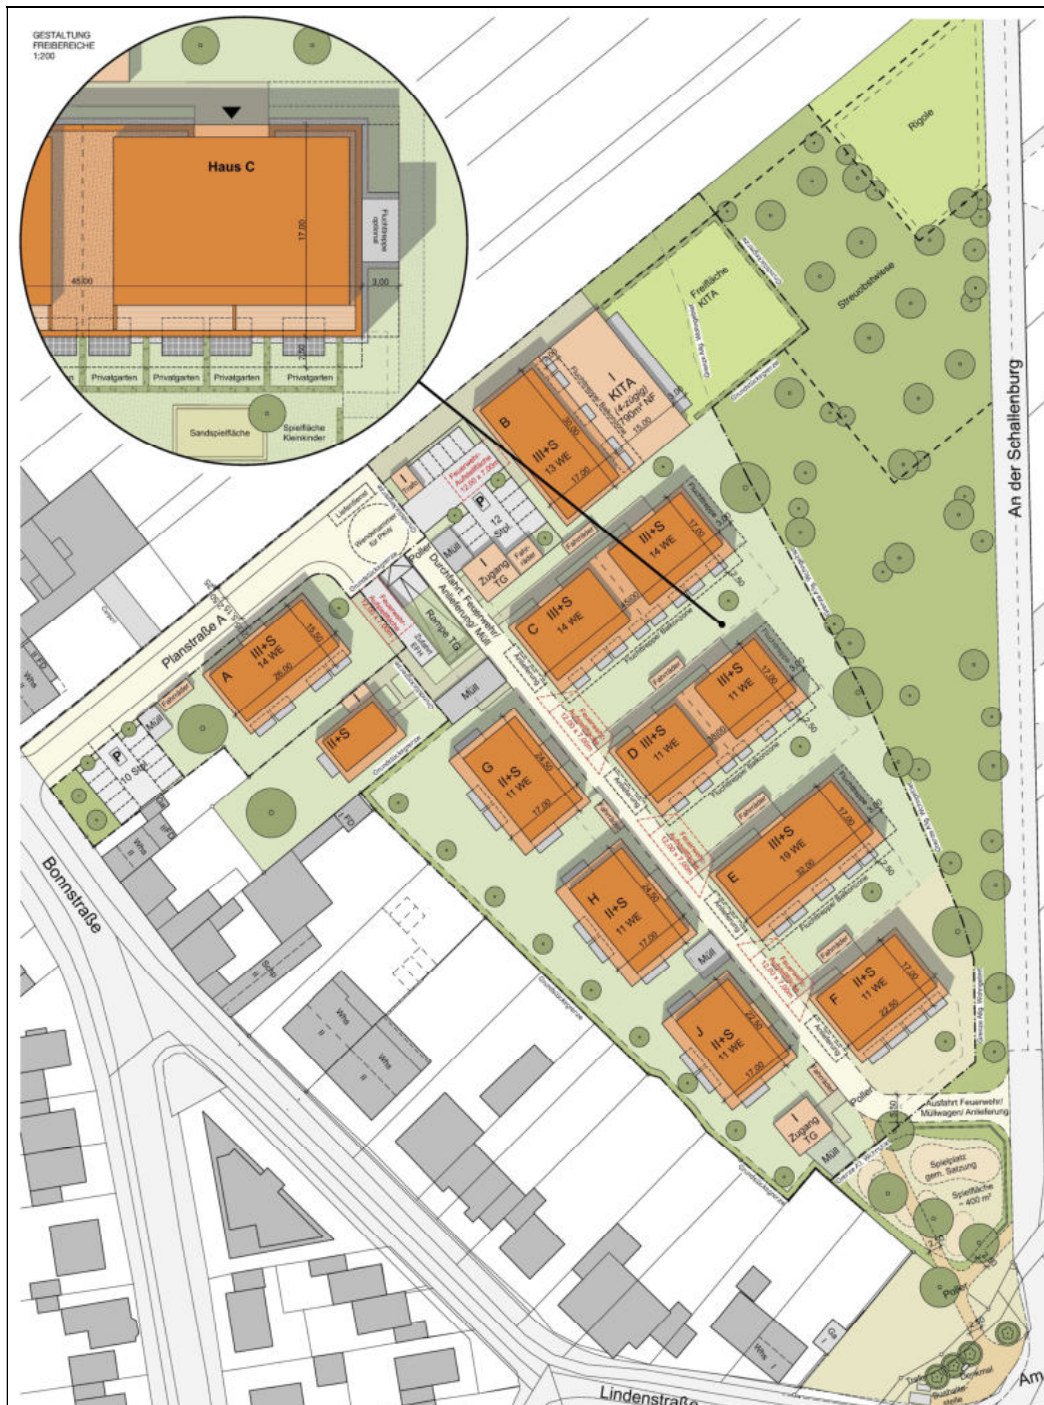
Städtebaulicher Entwurf zum B-Plan 05.10 (Neunwerk Architekten, 06/2025)
